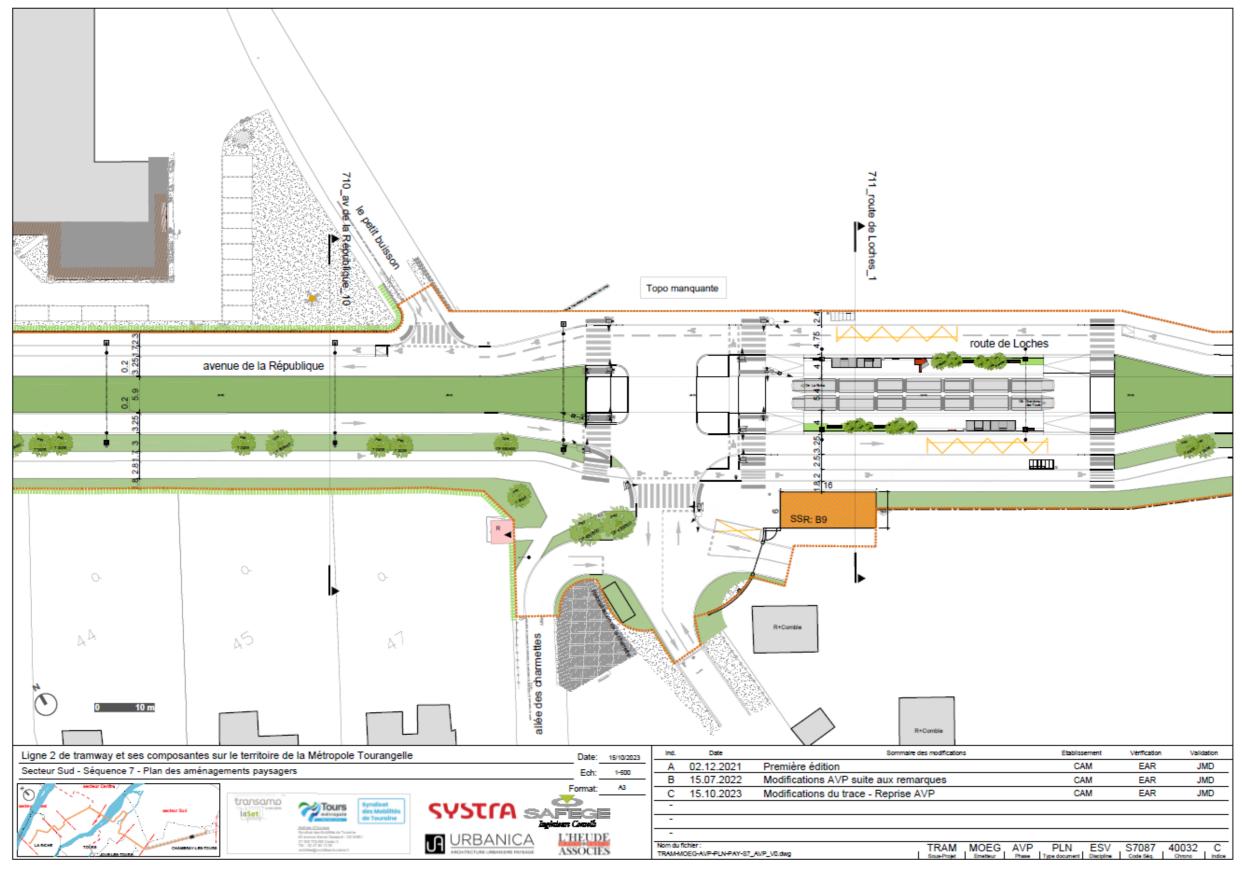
plan masse de localisation des arbres à abattre sur avenue de la République – Section 3 (planche 15)
